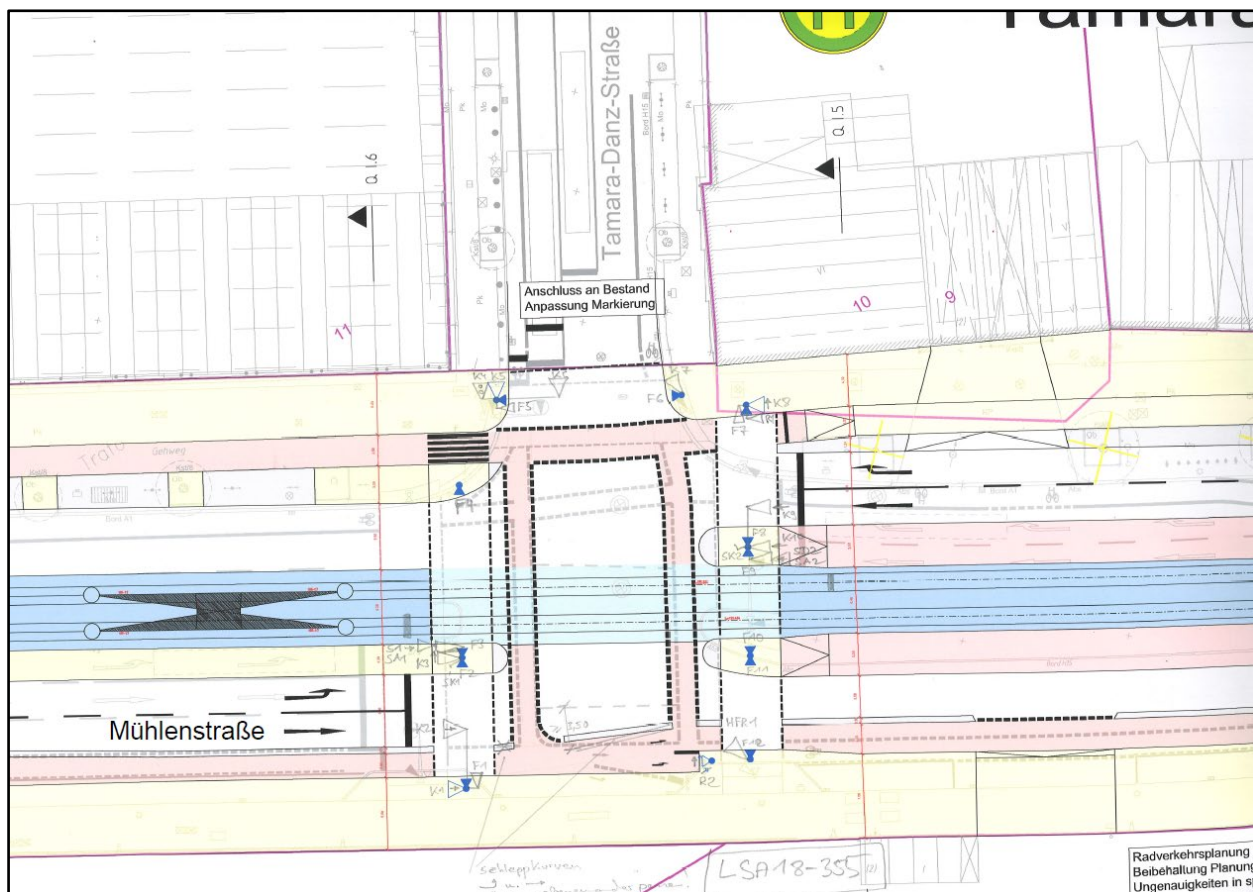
KP Mühlensstraße/Tamara-Danz-Straße mit Straßenbahn (Stand 02/2026)
